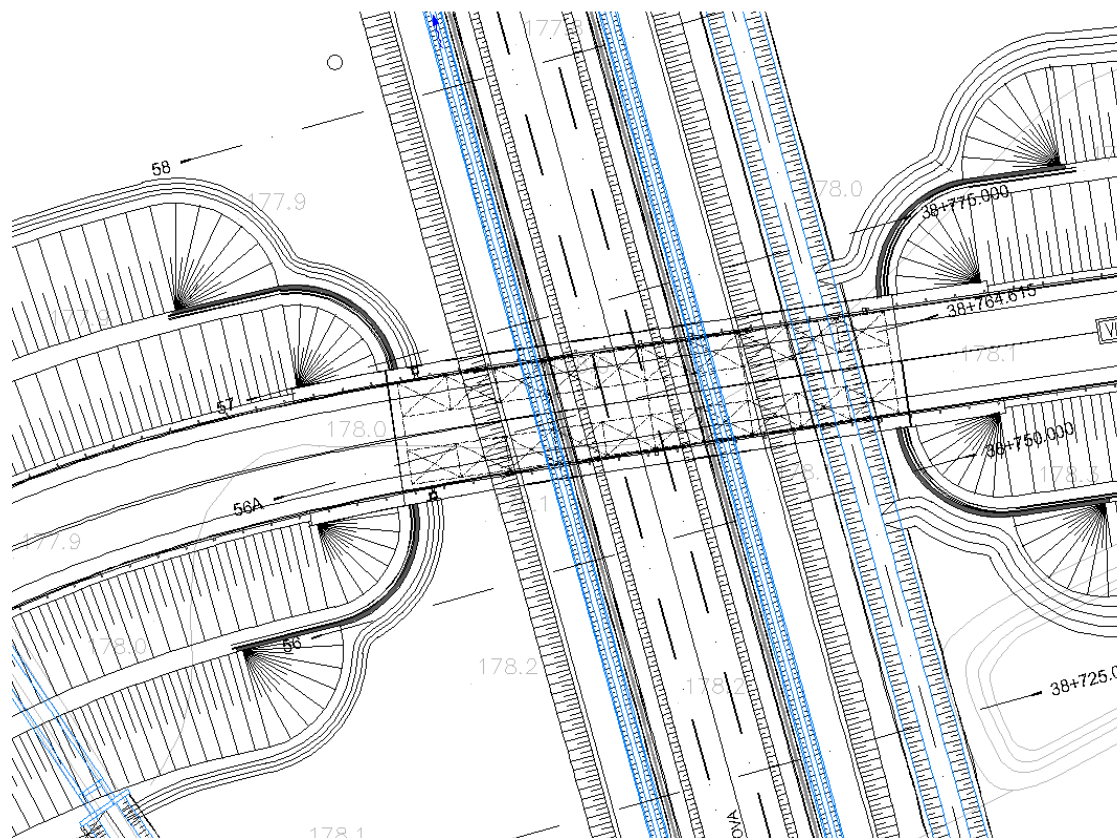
ubicazione planimetrica della deviazione del fosso.
